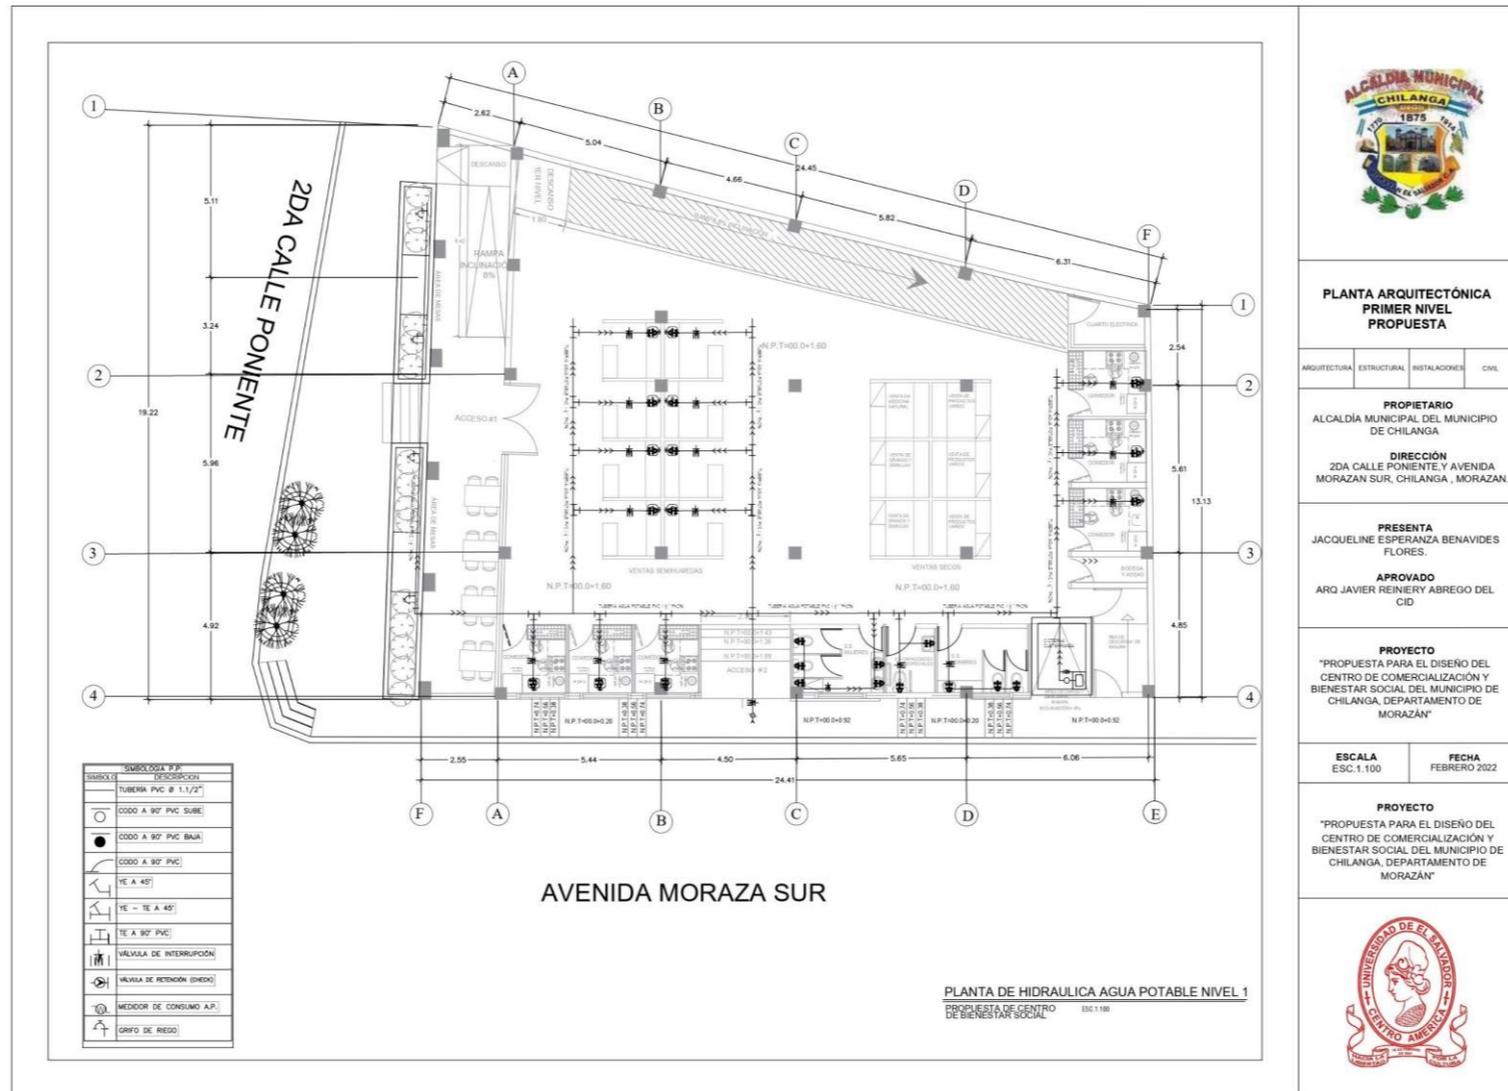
Planta hidráulica Primer Nivel Propuesta
